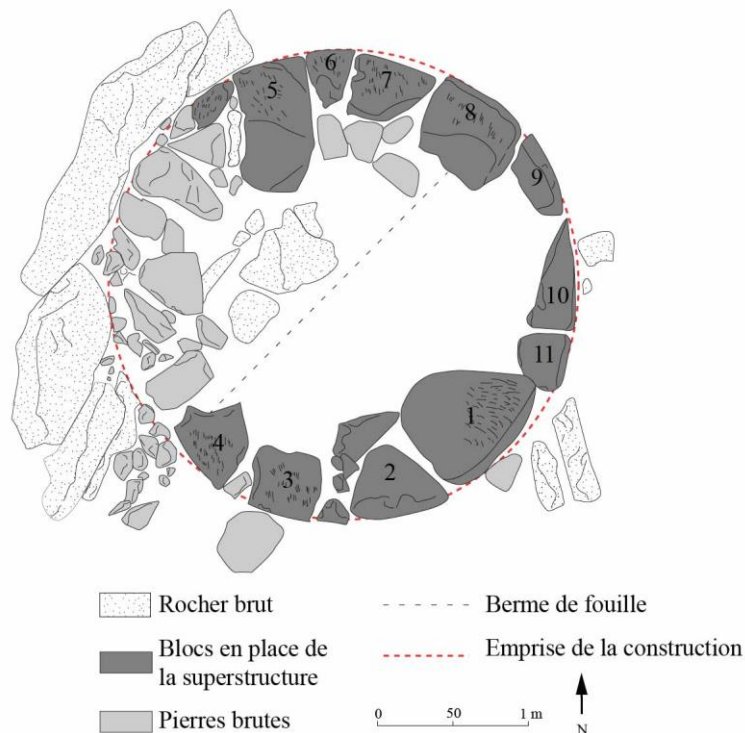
Relevé en plan de la structure J10 (échelle 1 : 50).
